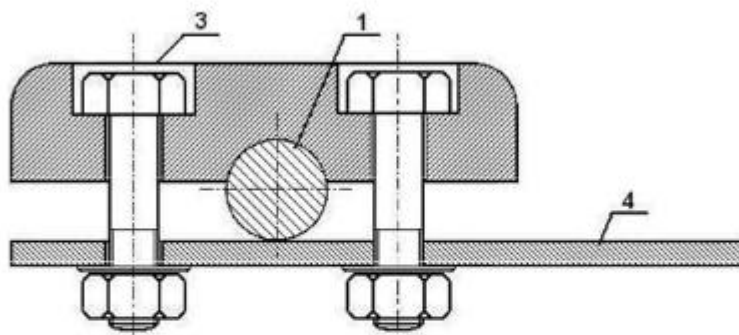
Connessione di un conduttore a nastro ad un ferro d'armatura
